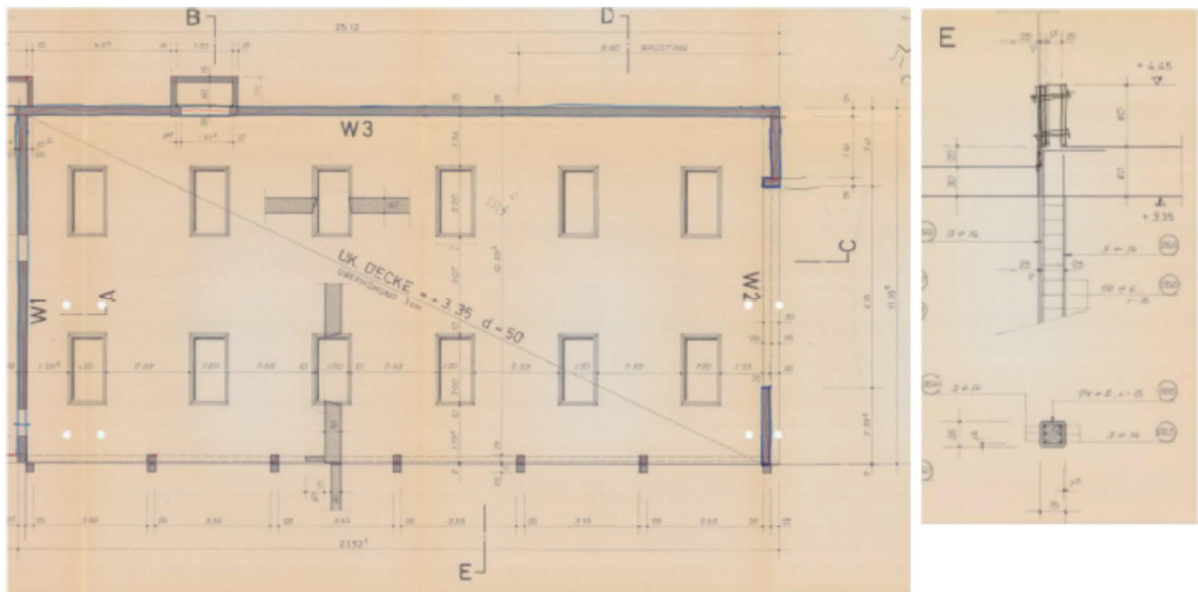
Plan horizontal de la partie 1 du bâtiment examinée « Garage » (à gauche) et détails des piliers (à droite).
